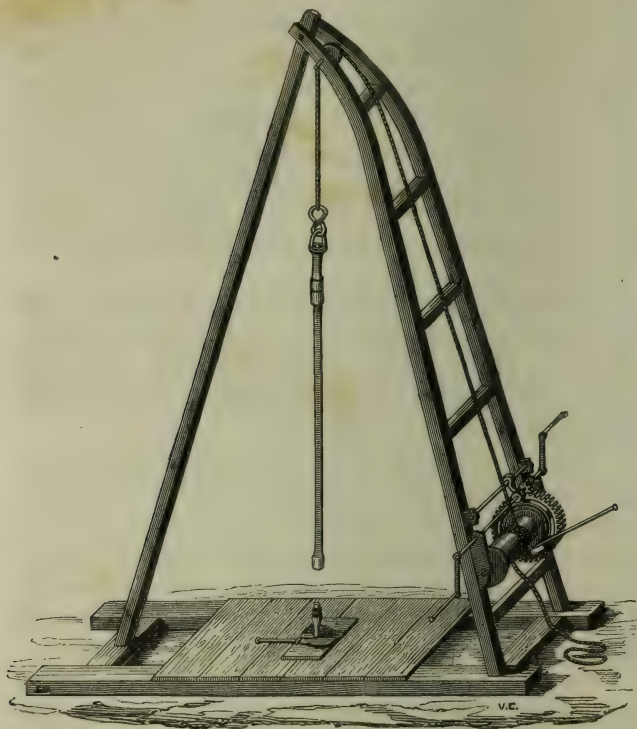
Chèvre à tambour avec roue d'engrenage et poulie de frein.
